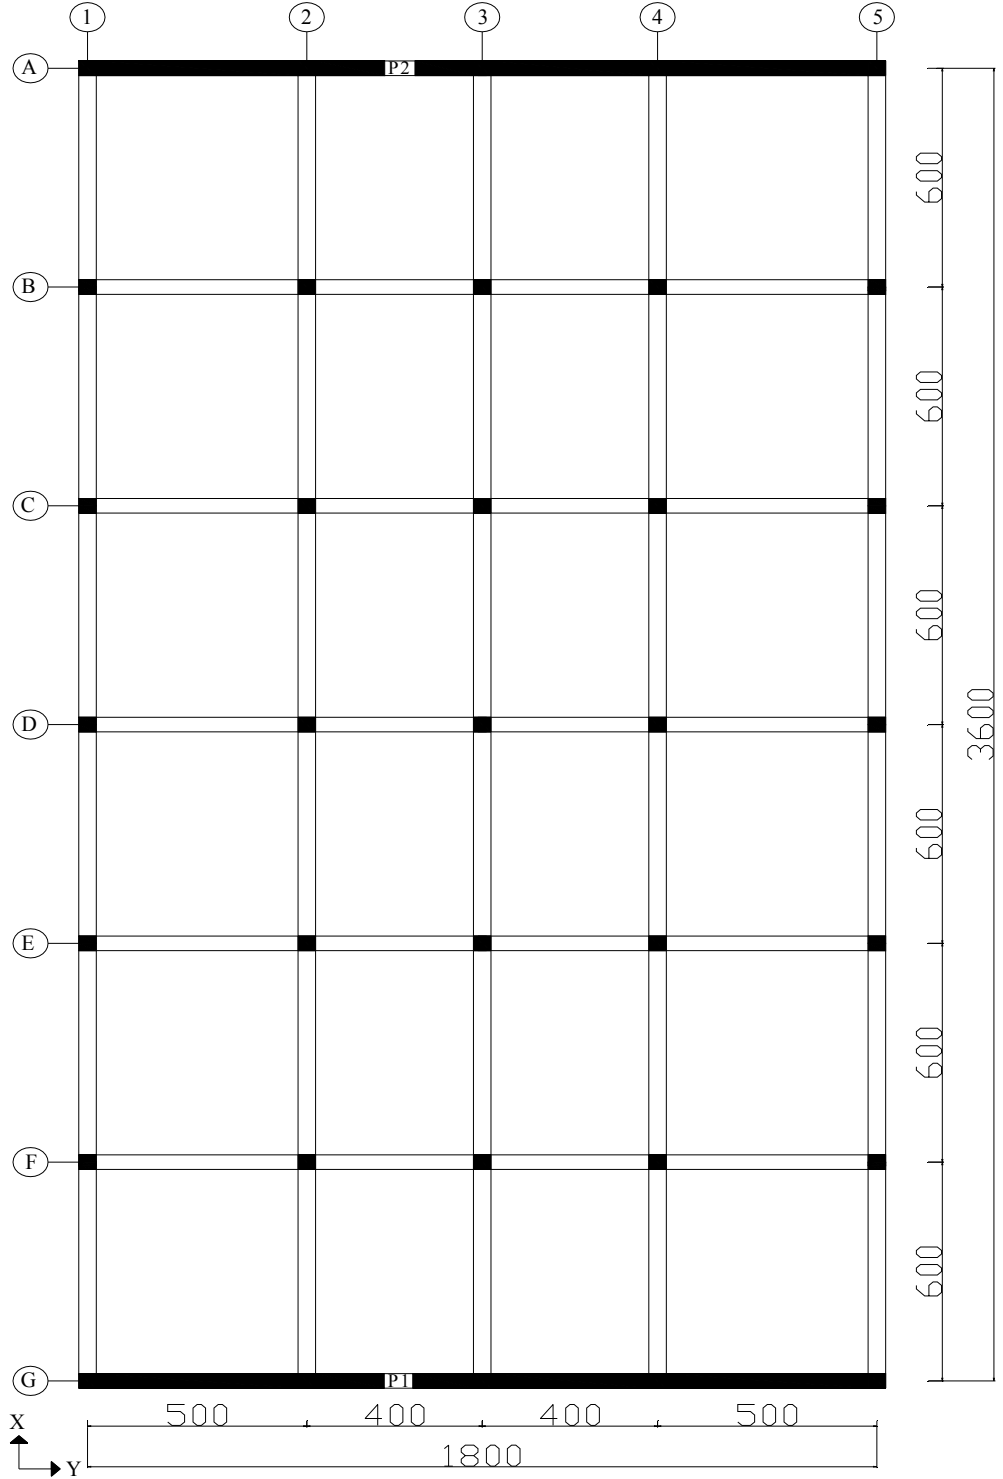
Örnek 5.7'nin kat kalıp planı
